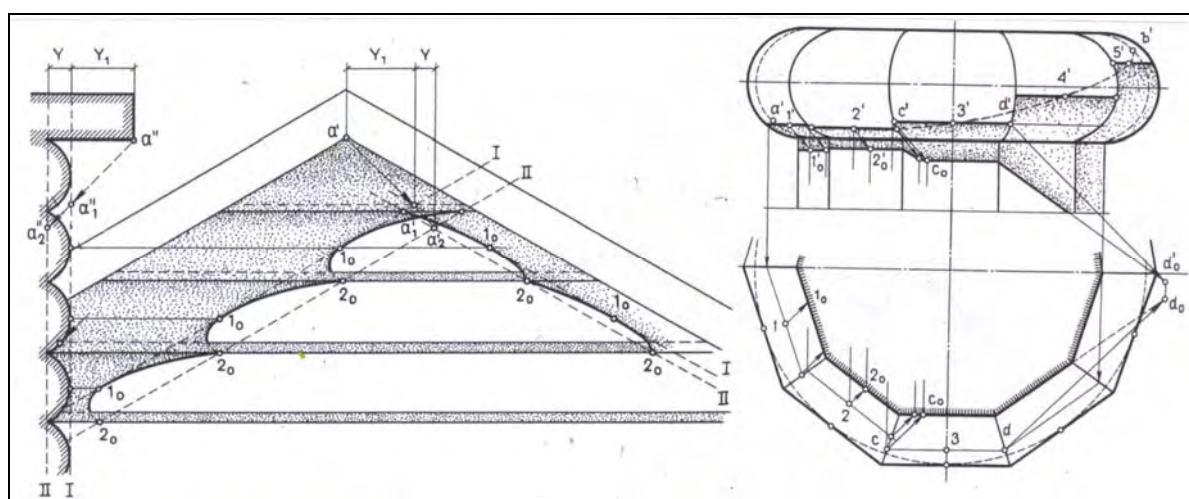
Тени сложных архитектурных форм: *а* — тень от фронтонной кровли на бревенчатую стену; *б* — тени граненого столба и плиты
